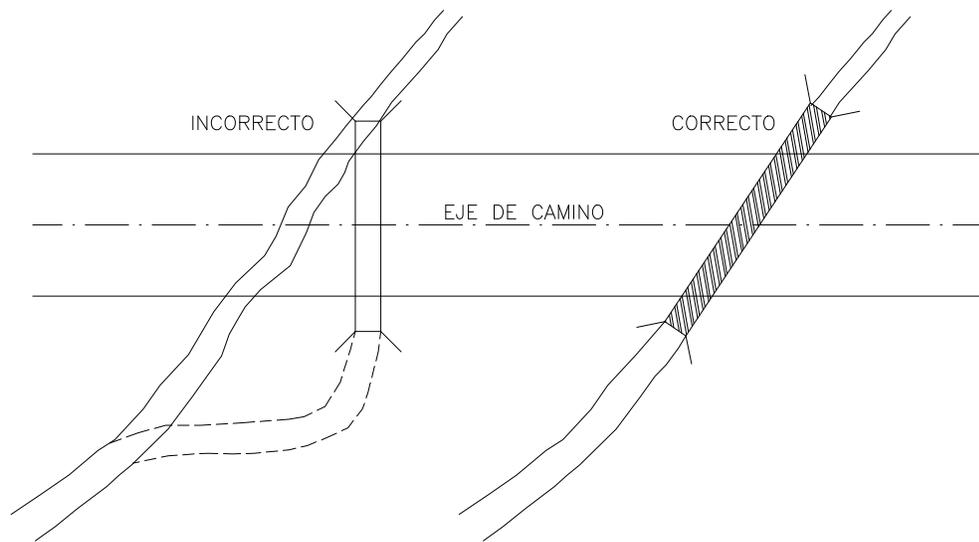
ALINEACIÓN DE TUBERÍA Y ANGULO DE ESVAIAJE EN ALCANTARILLAS.
